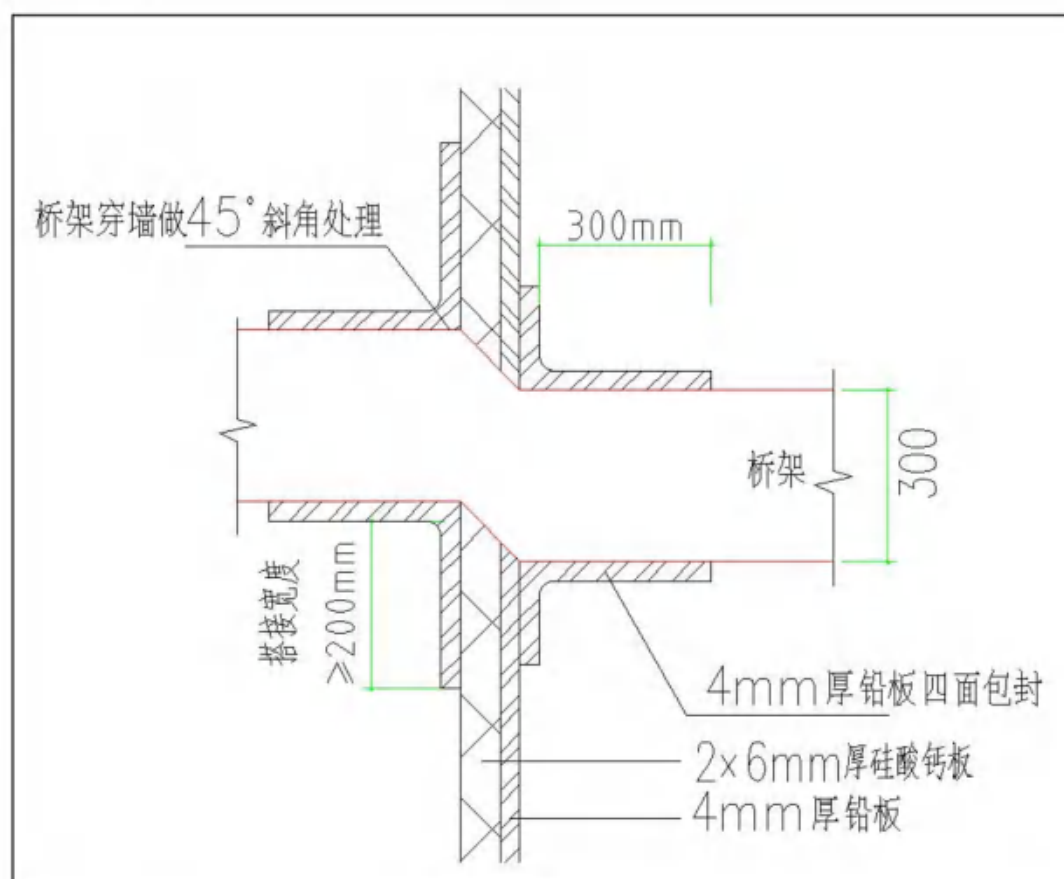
a 项目 DSA 机房电缆穿墙平面示意图
